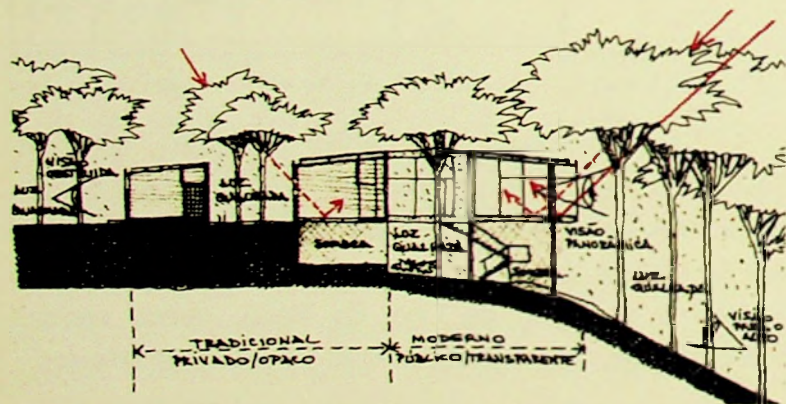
Croqui corte transversal esquemático Casa de Vidro.
